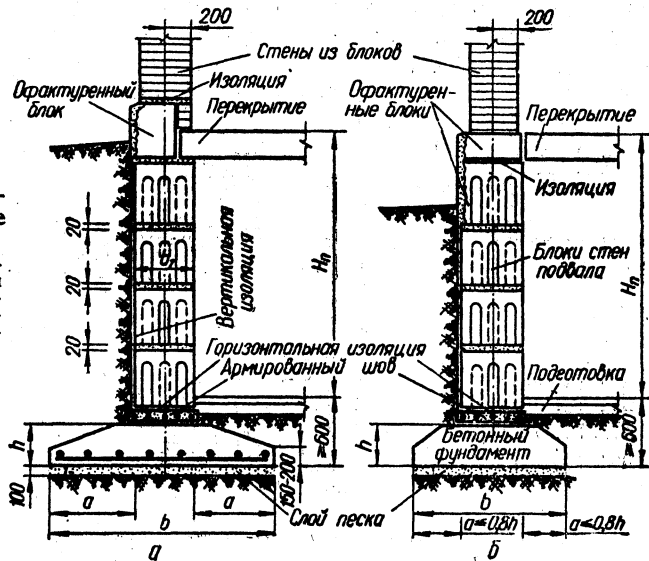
Сборные фундаменты под внутренние стены: a — железобетонные при опирании панелей перекрытия на стены подвала; b — бетонные, когда панели перекрытия не опираются на стены подвала и $a < 0,8h$.
